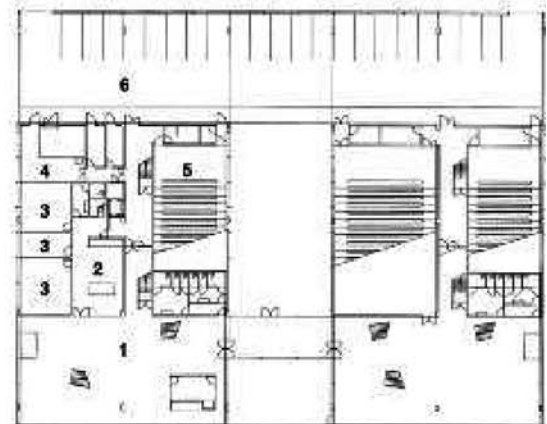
Beispiel Bürobau aus Leicht und Schwer, „Preiswerte Kunst-Hülle“ (Lacaton & Vassal): Eine einfache Stahlbetonstruktur bildet das Tragsystem; vorgefertigte Stahlbetonrippendecken ermöglichen die 10,50 m x 12 m große Spannweite, in der eine leichte Sekundärstruktur zur flexiblen Raumgliederung eingesetzt wurde. Durch die Einfachheit des Entwurfs und die leichte Ausführung der Sekundärstruktur konnte das Raumprogramm um ca. 25 % erweitert werden (Dworschak & Wenke 1999, 115).
